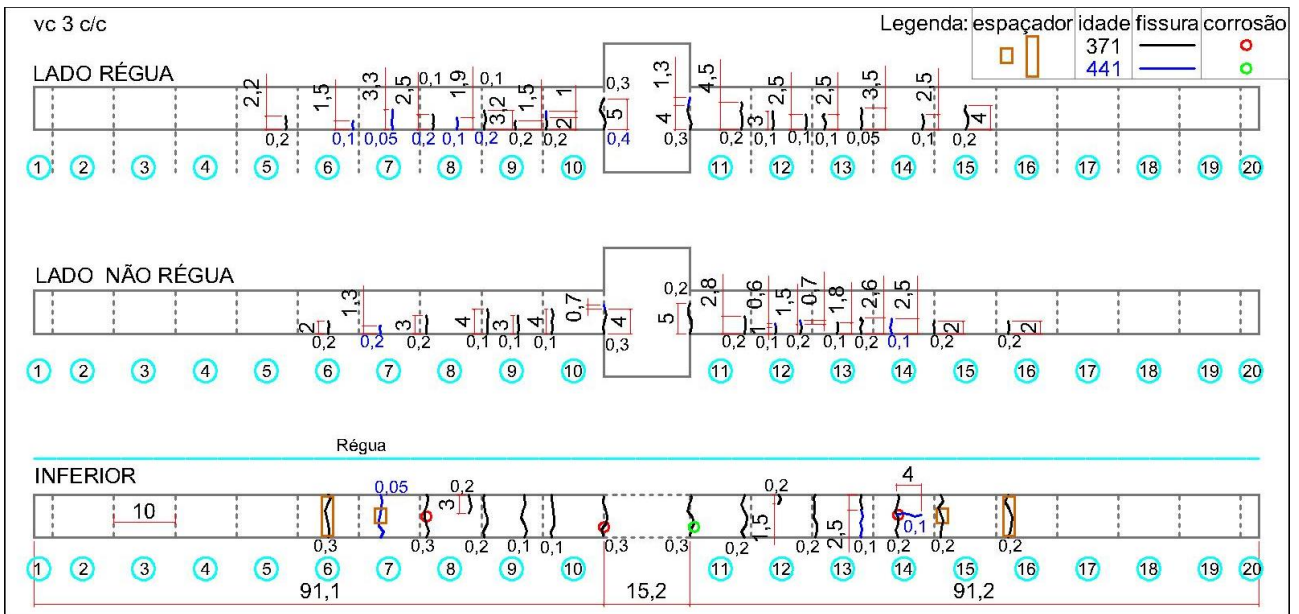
Mapa das fissuras na viga vc 3 c/c
